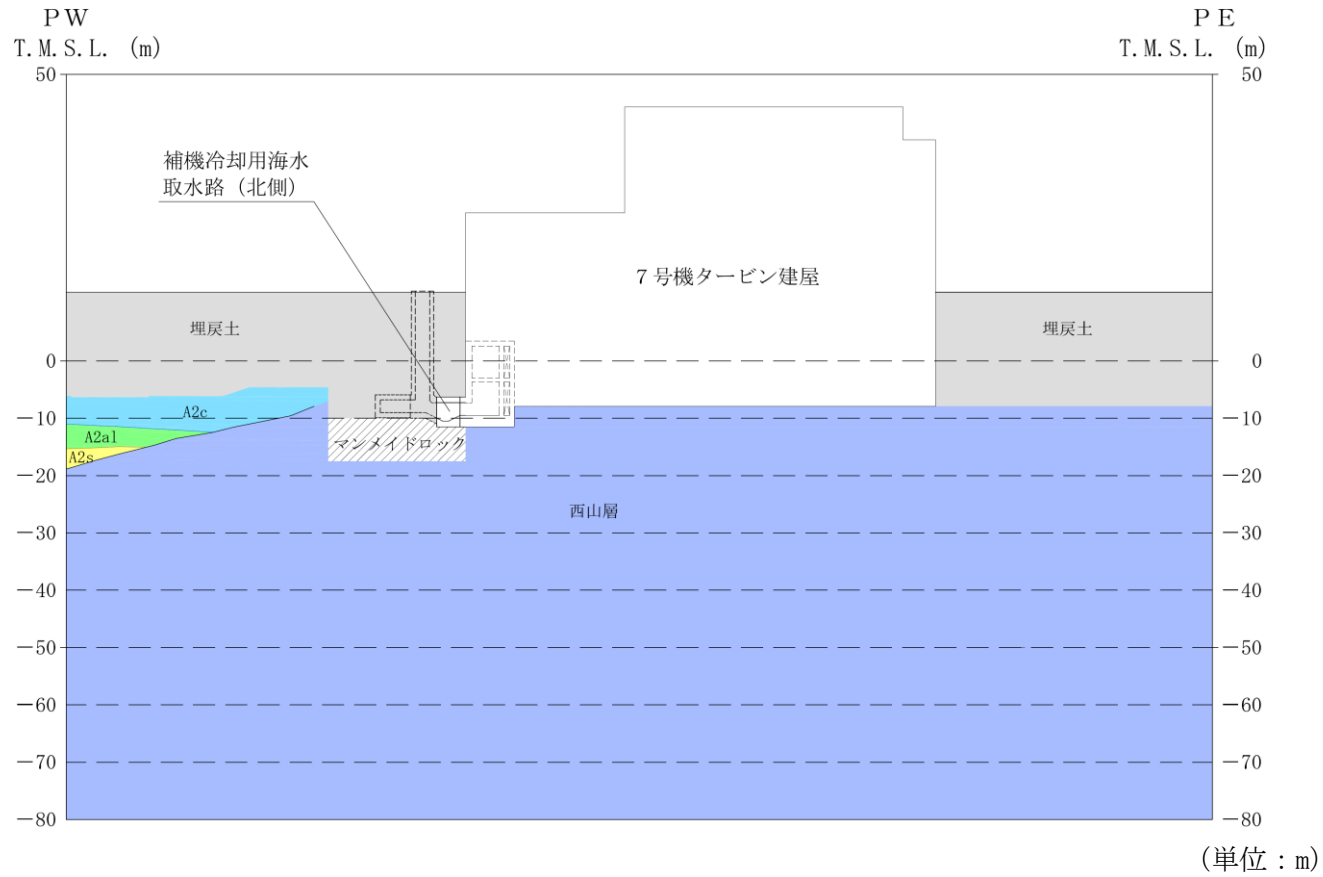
(3) 補機冷却用海水取水路の評価対象断面図 (北側, C-C 断面)
